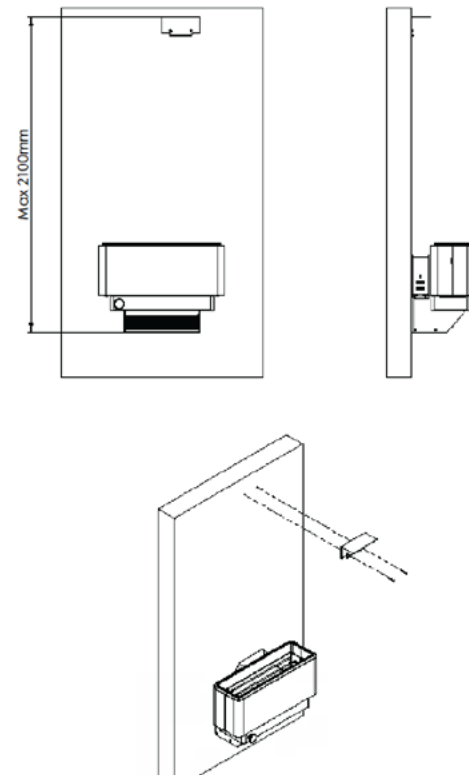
Anbringen und Befestigung der Abzugskappe
